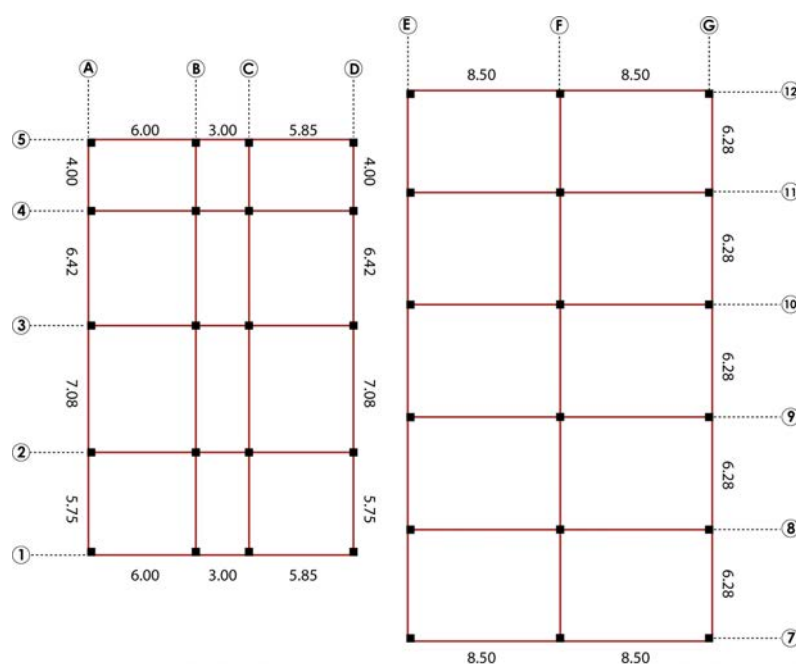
Distribución estructural del proyecto. Elaboración: Propia.
